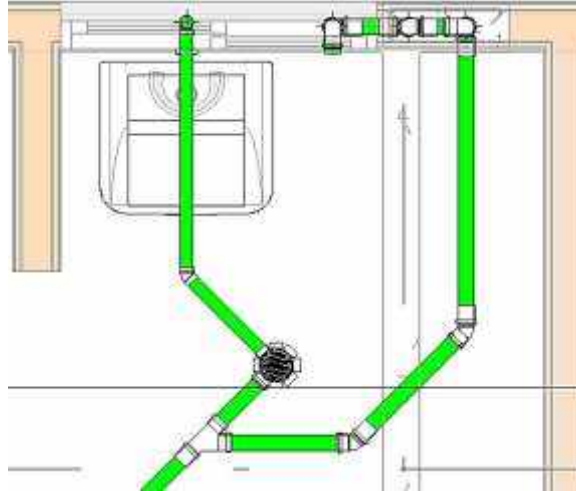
Modelagem BIM 3D: sistema de esgoto da lavanderia (corte)
